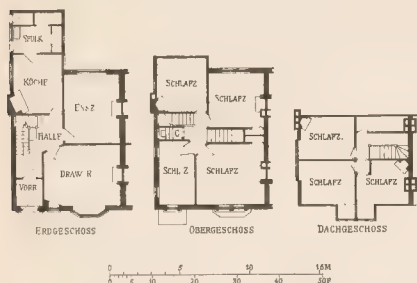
101. Grundrisse eines Doppelhauses der Kolonie Bedford Park bei London. Von R. Norman Shaw. Erbaut um 1880. 1:400.
